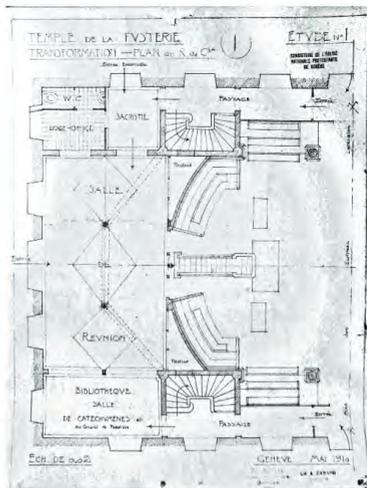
Plans de rez-de-chaussée, projet de Leclerc et Gambini, 1910. Variantes du projet actuel, avec un grand espace d'entrée-hall sur la façade nord (côté lac) et deux cages d'escaliers donnant accès à la galerie.
